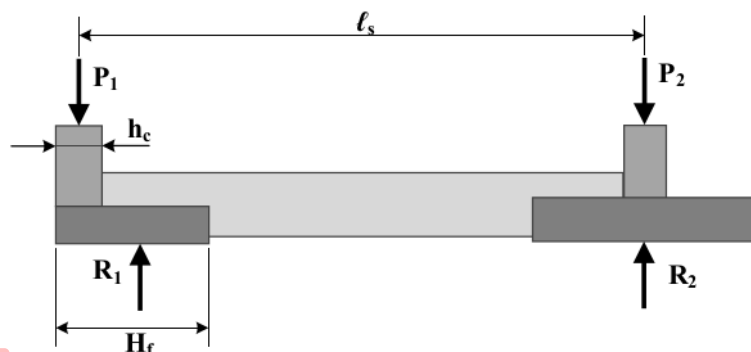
Tipe-tipe fondasi tapak gabungan.
